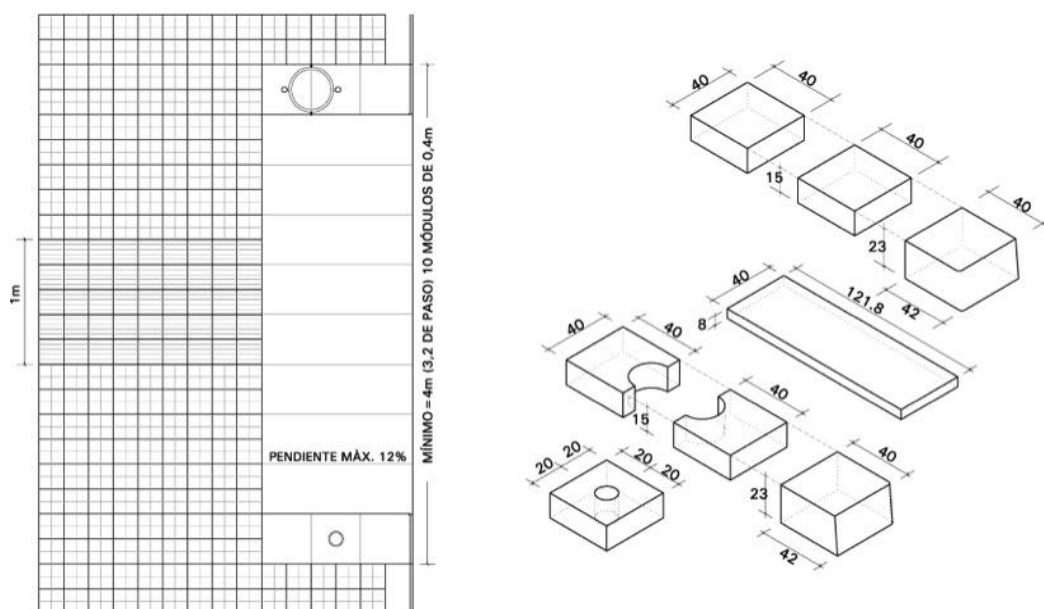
> Vado para peatones V-120 con piezas de granito, caras vistas flameadas
